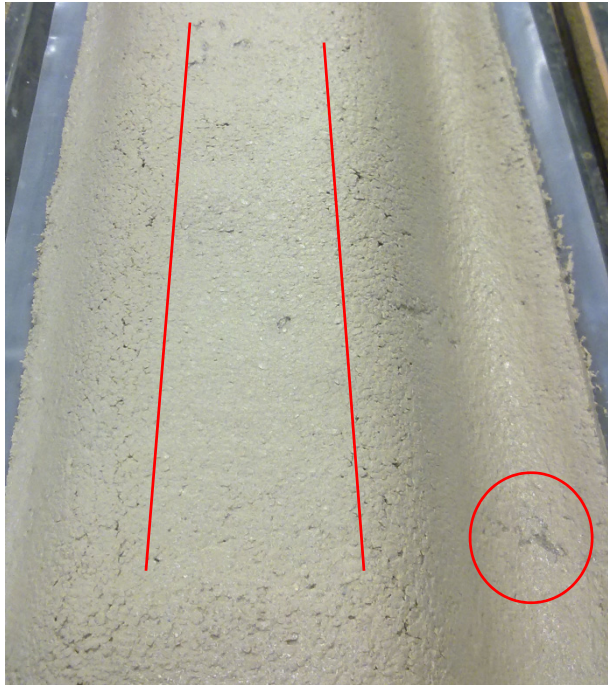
Segmento de una teja con árido calizo, las líneas rojas muestran la dirección de las grietas poco profundas
